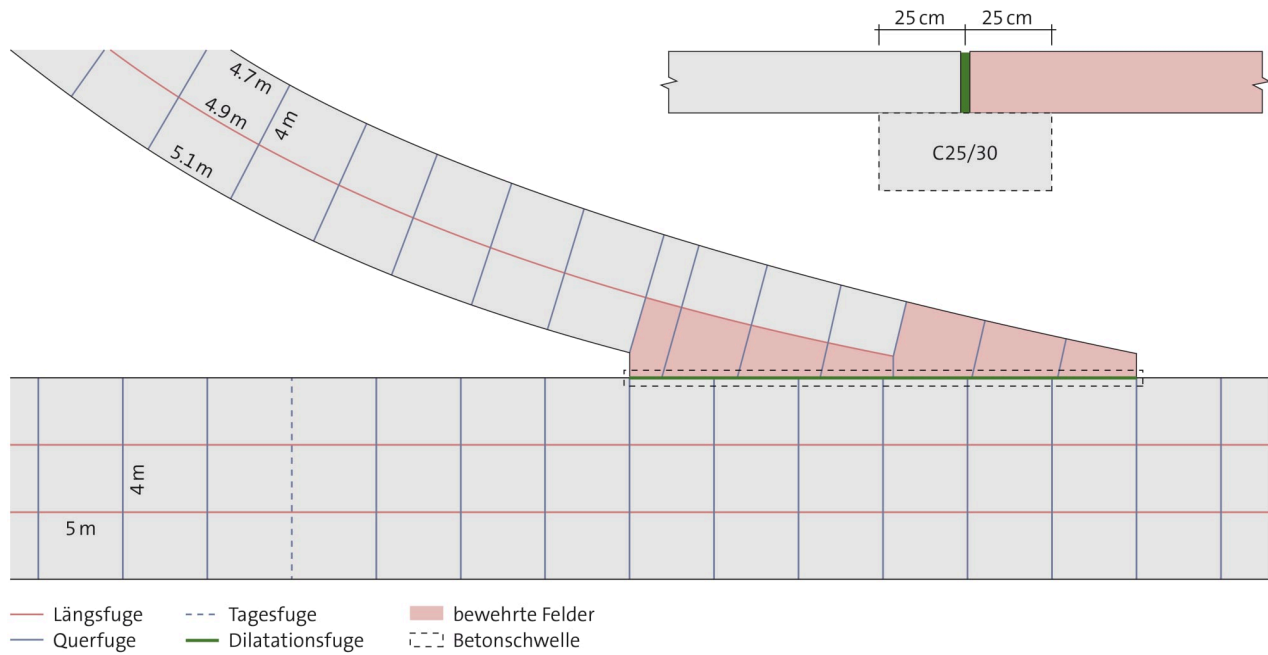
Fugenarten in Betondecken. Detail rechts: Betonschwelle unter einer Dilatationsfuge.
